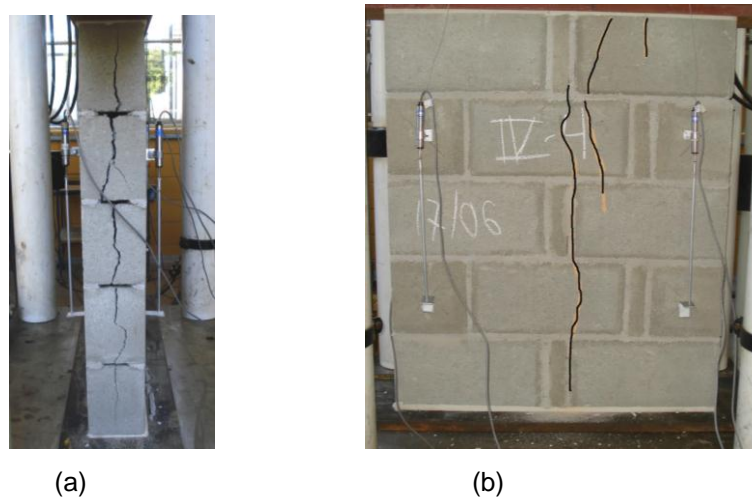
Vista lateral (a) e vista frontal (b) da mini-parede com argamassamento lateral com rapaduras (Série IV).
